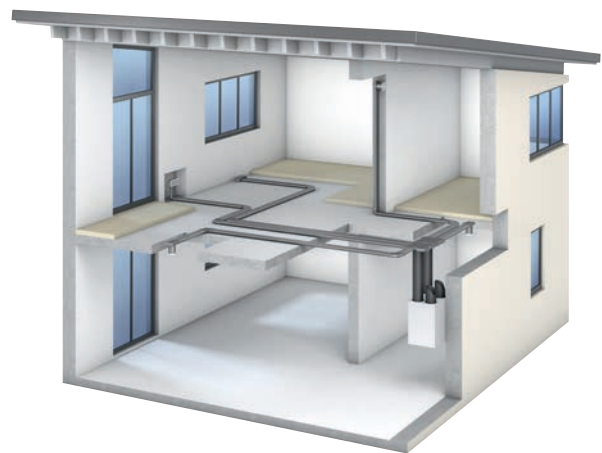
Zentrale Wohnraumlüftung im Fußbodenaufbau integriert
